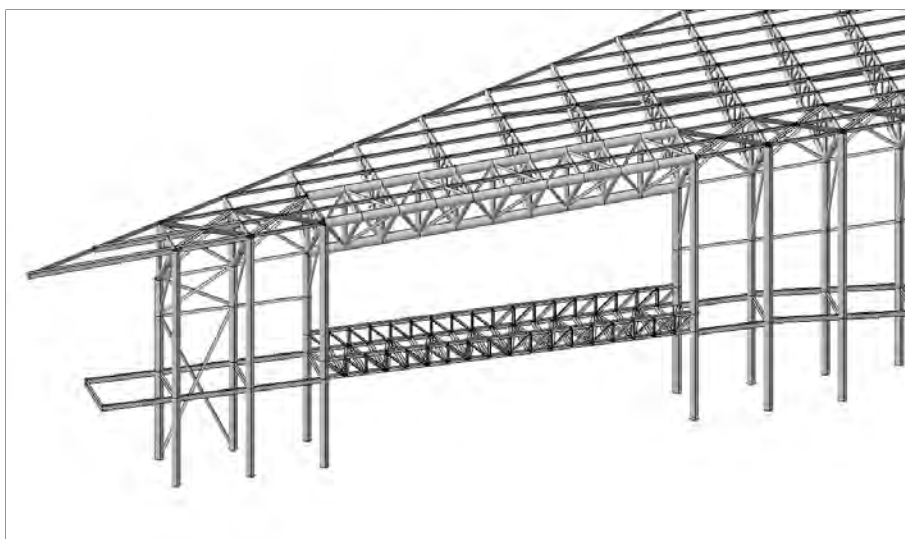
Trave reticolare spaziale e passerella a sbalzo su Via Marghera.
